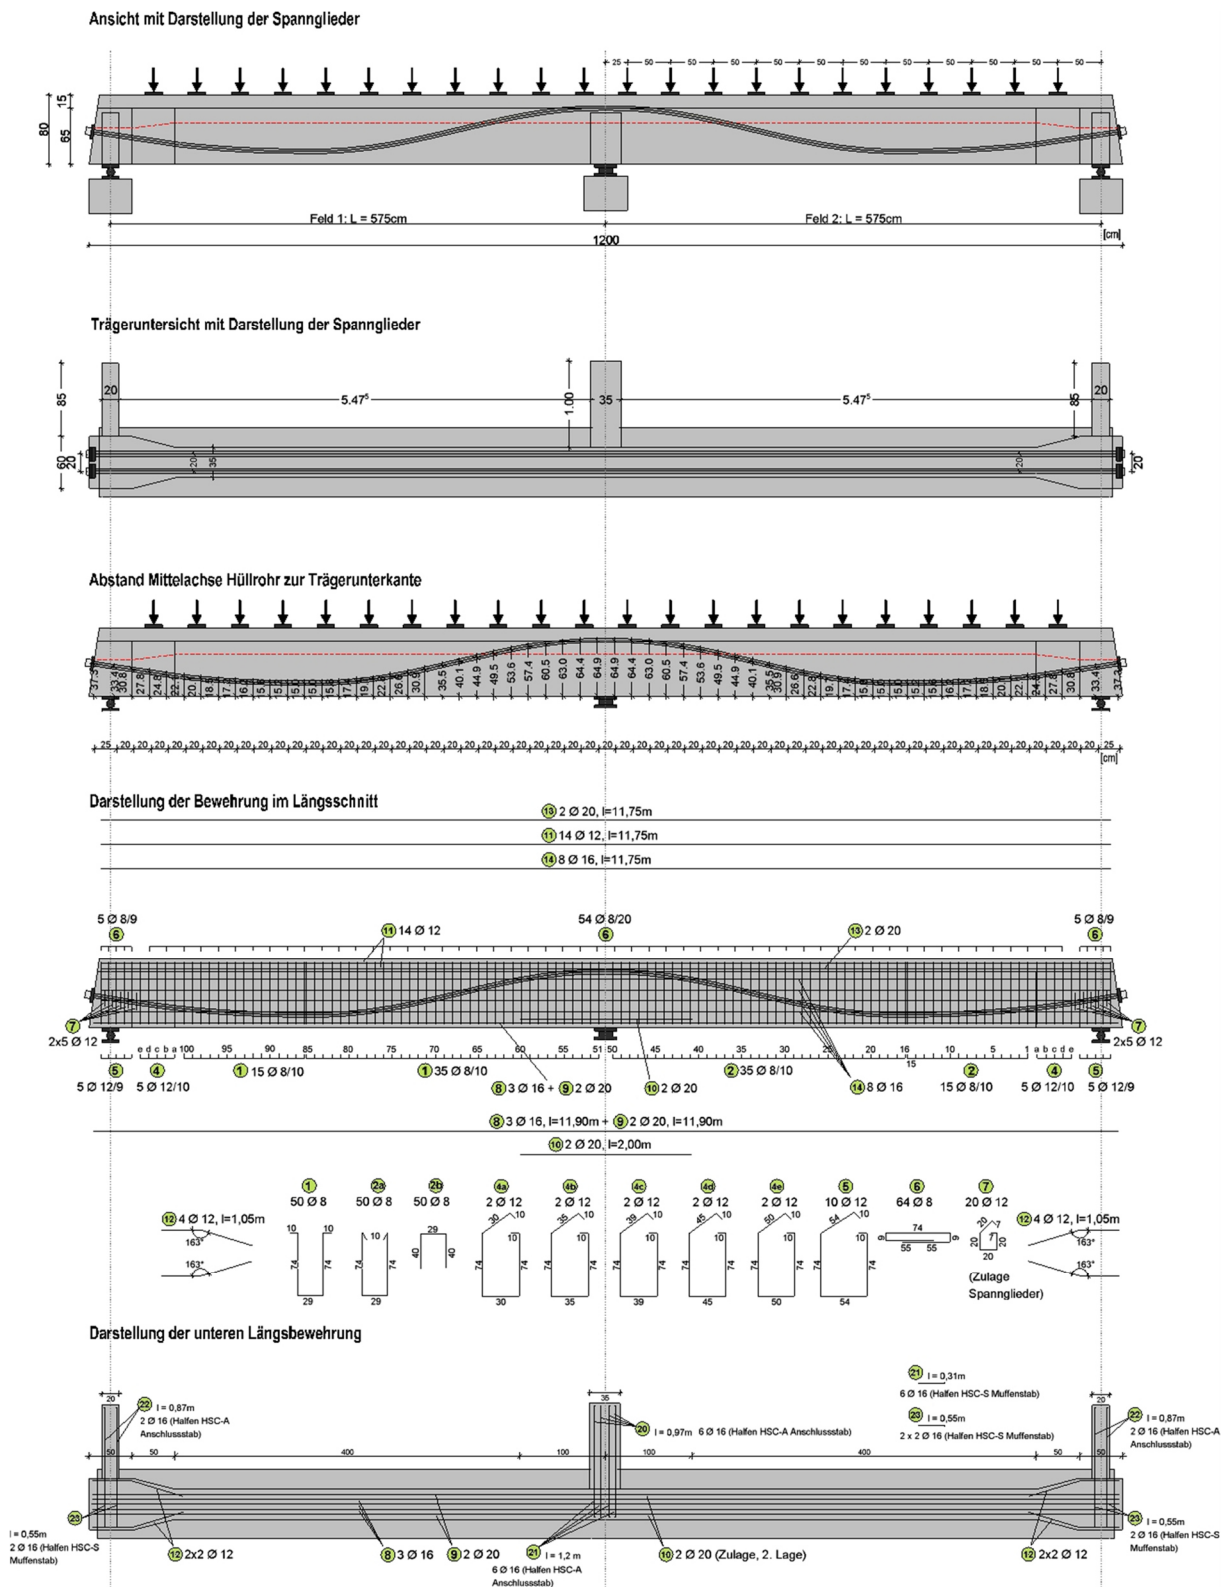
Bewehrungsplan Versuchsträger DLT 8
